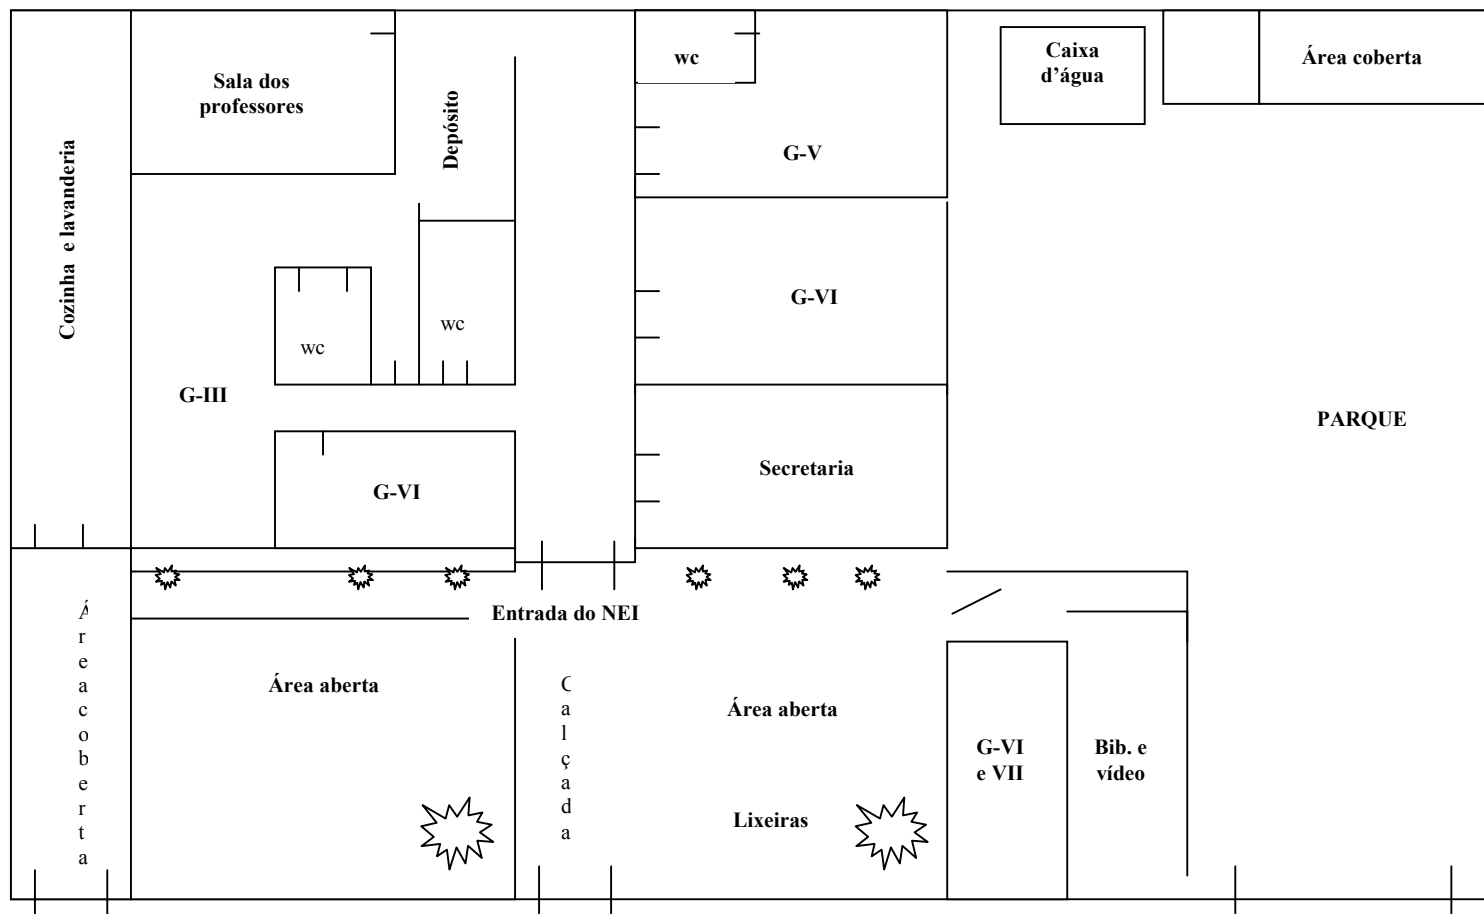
A INSTUIÇÃO EM PLANTA BAIXA
